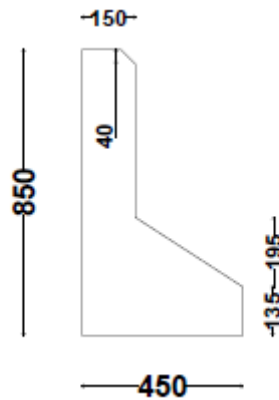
Sección Transversal. Barrera Tipo Jersey
